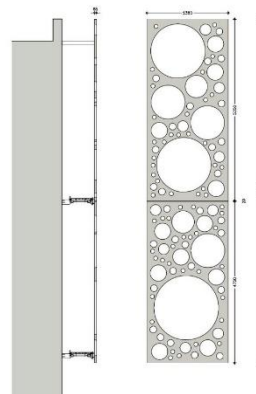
The CRC façade by MOE ARCHITECT – C.F. Møller Architects. Fuente: <https://www.floornature.com/architectural-solutions/crc-facade-cf-moller-moeas-sdu-technical-faculty-14111/>
